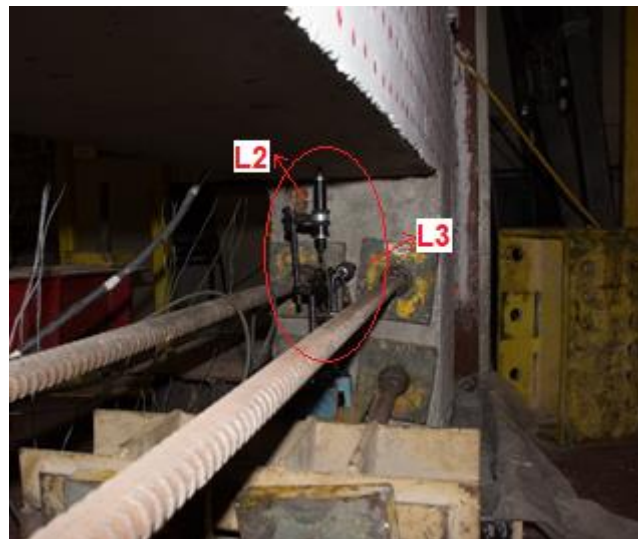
LVDT's no alinhamento do pilar da esquerda: L2 na direção vertical e L3 na direção horizontal, no plano do pórtico.
